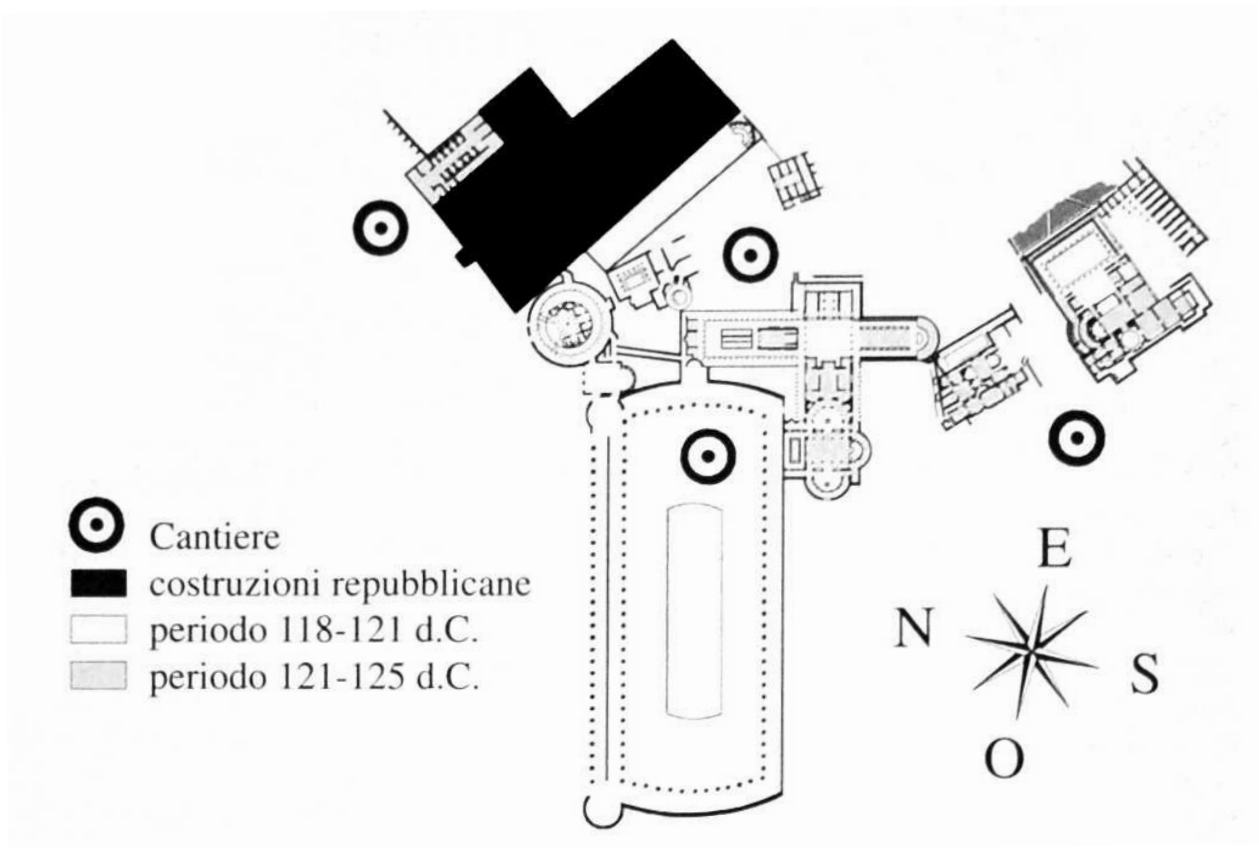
Ipotesi sulla possibile posizione dei cantieri necessari per la prima e seconda fase di lavori (121-125dC)
